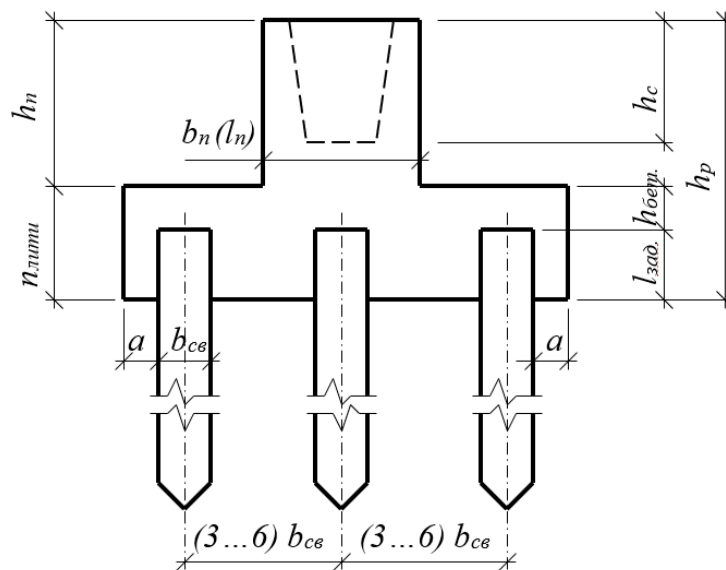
Конструювання ростверку у вертикальній площині
